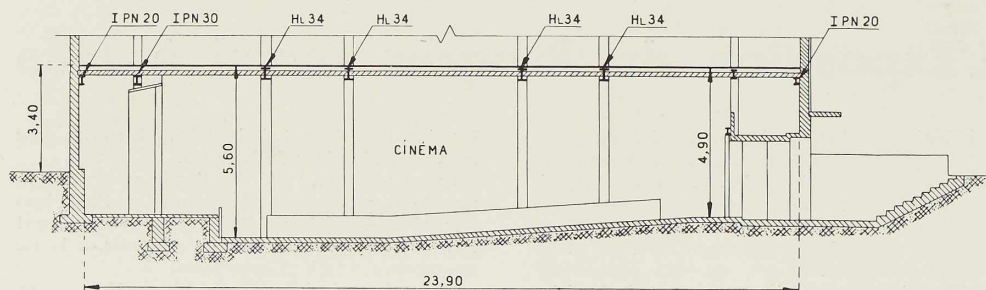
Coupe à travers le cinéma situé au sous-sol en dessous de l'entrée principale.
